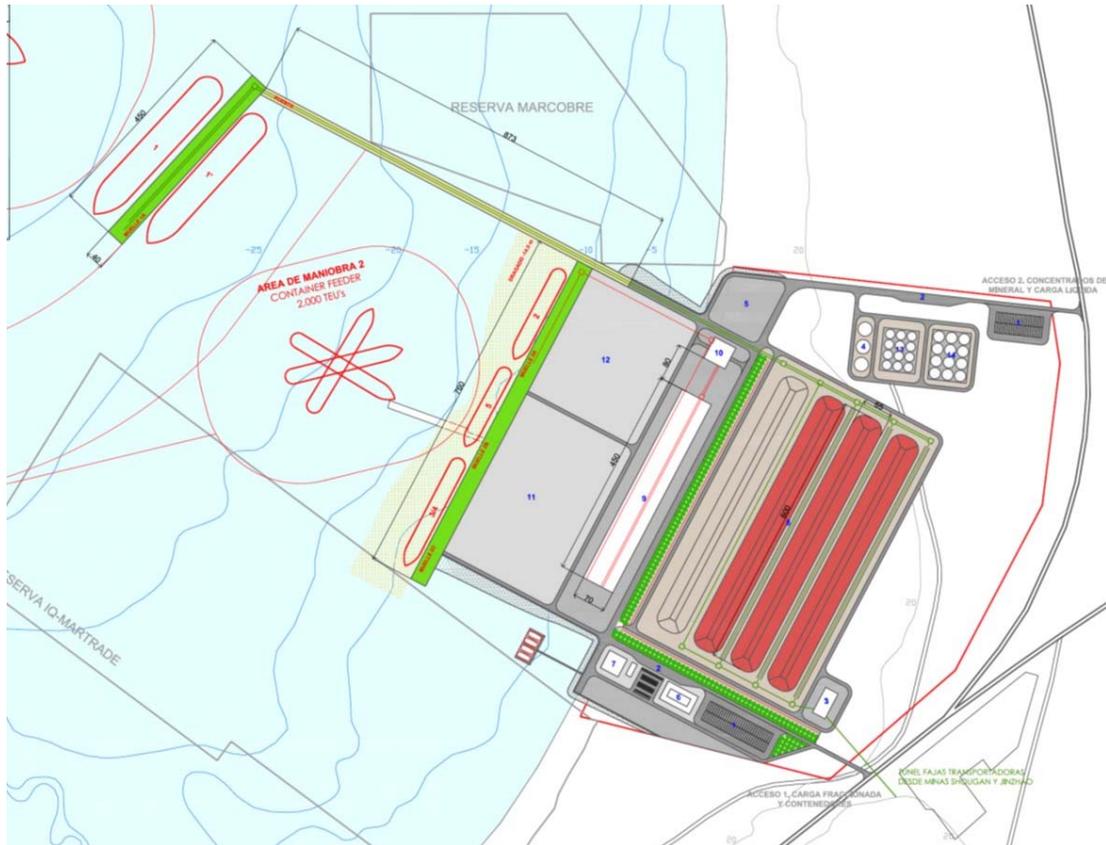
Vista de Planta de la Propuesta de Desarrollo (escenario moderado)
